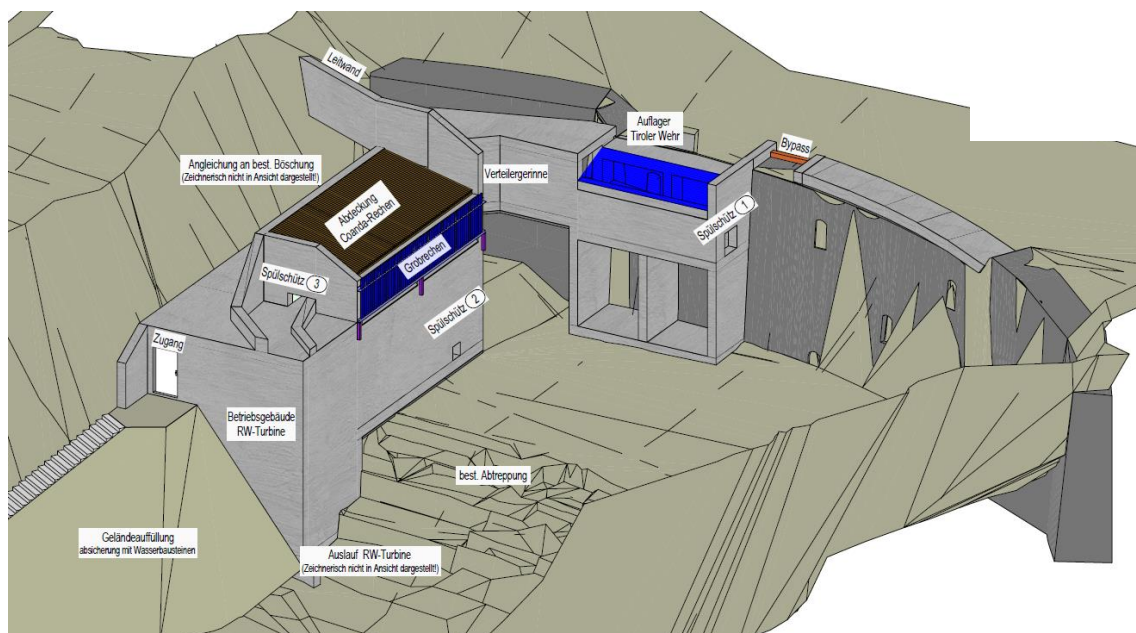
3D Ansicht geplantes Fassungsbauwerk
